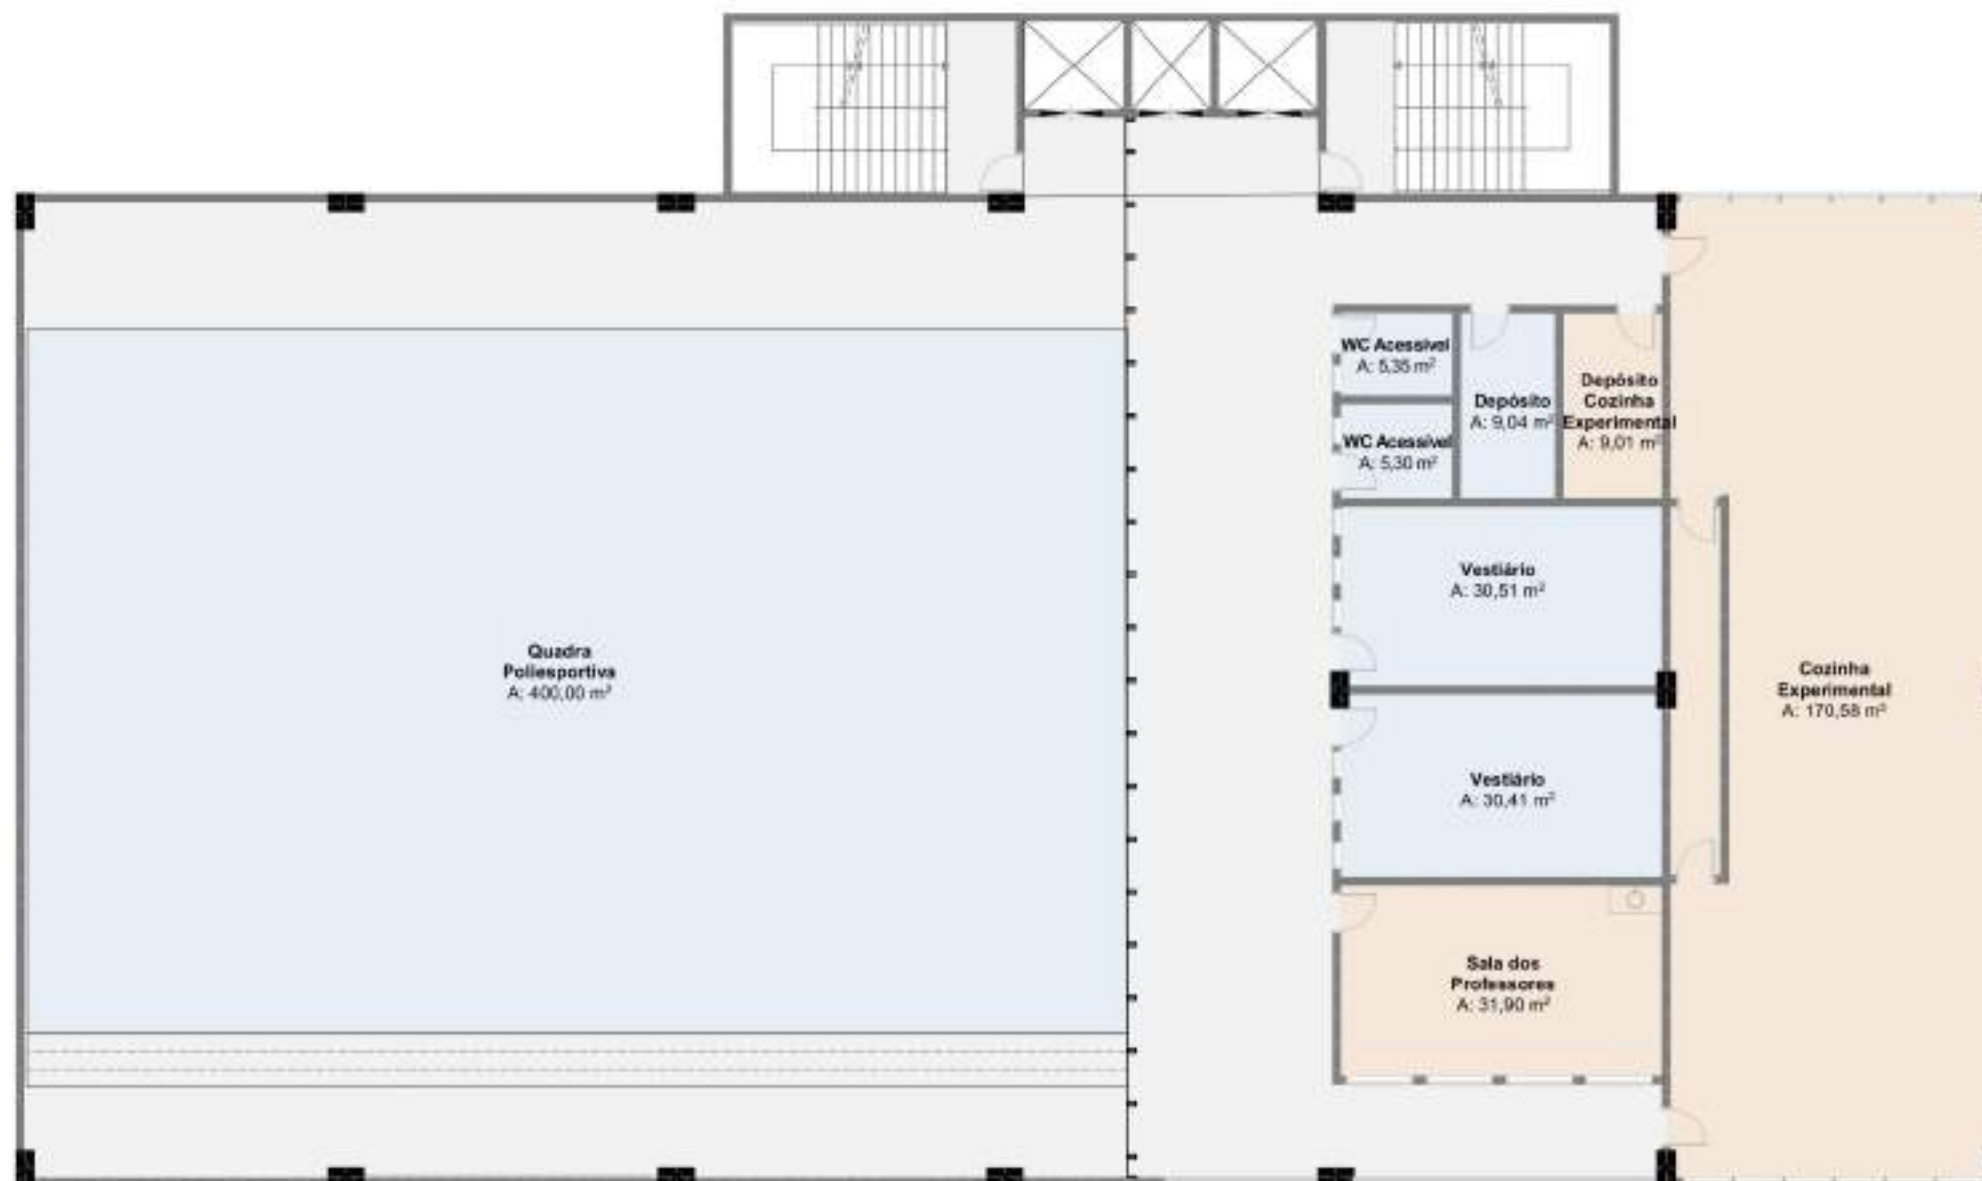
Planta Referencial Primeiro Pavimento - MINICEU Tipologia 2
